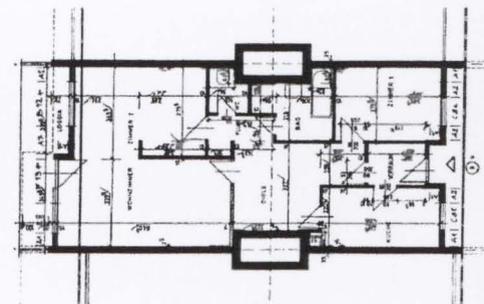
Terrassenhaussiedlung, Grundriss Typ i
